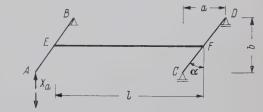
Vereinfachtes statisch bestimmtes Hauptsystem eines schiefen Hohlkastens
